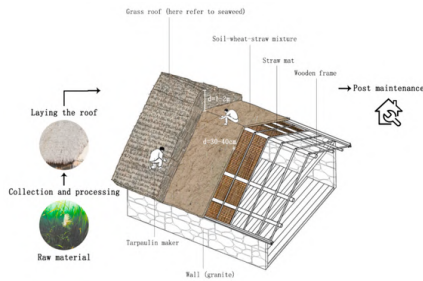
Fuente: web mdpi. Imagen de sistema constructivo de cubierta algal.
